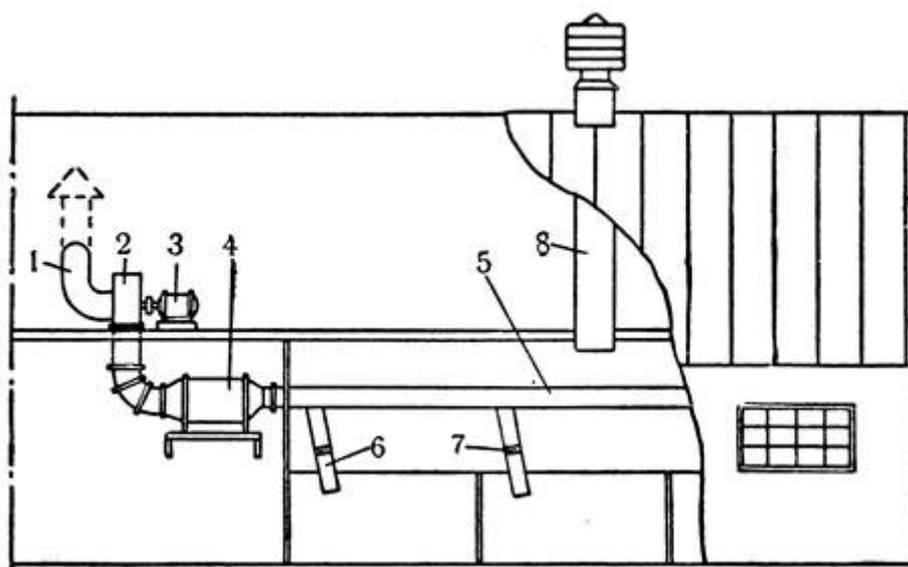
Схема установки вентиляции с электрическим подогревом воздуха
